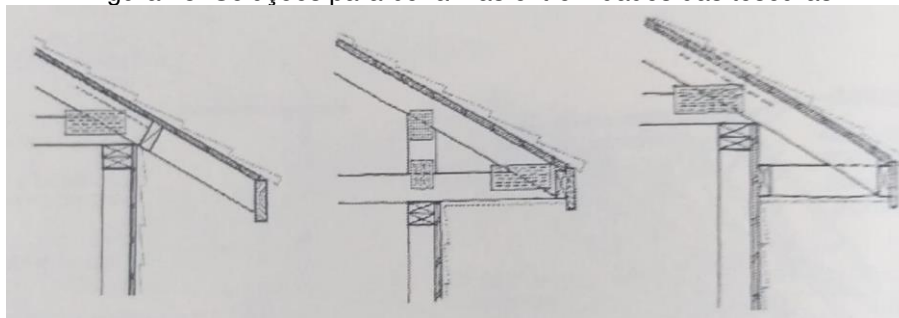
Esquema de configuração do beiral paralelo às tesouras
